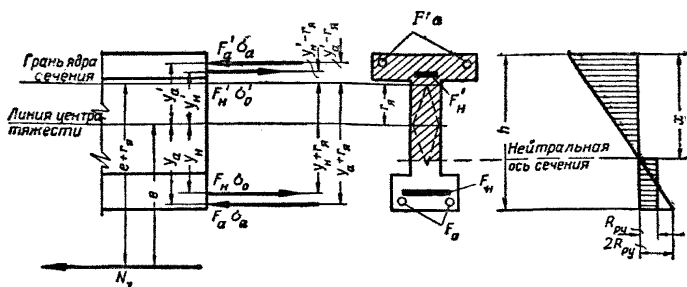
Схема распределения напряжений и усилий предварительно напряженного внецентренно растянутого элемента при расчете трещиностойкости зоны, содержащей арматуру F'_H и F_a
